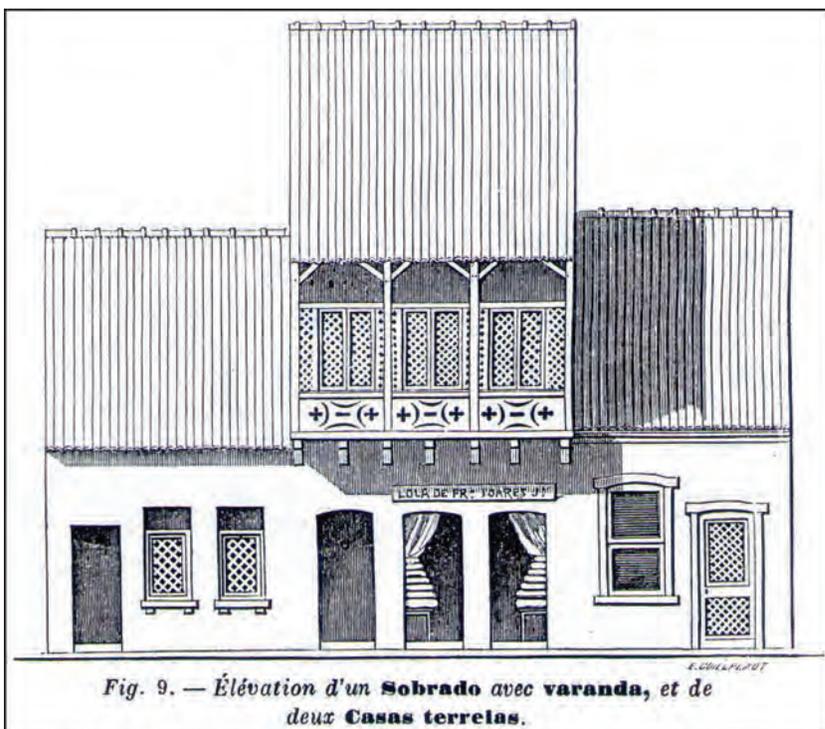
Elevação de um sobrado e casas térreas urbanas.
